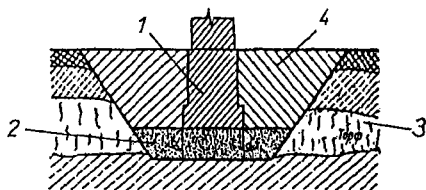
Замена слабого грунта песчаной или гравелистой подушками: 1 — фундамент, 2 — песчаная подушка, 3 — слабый грунт, 4 — обратная засыпка
